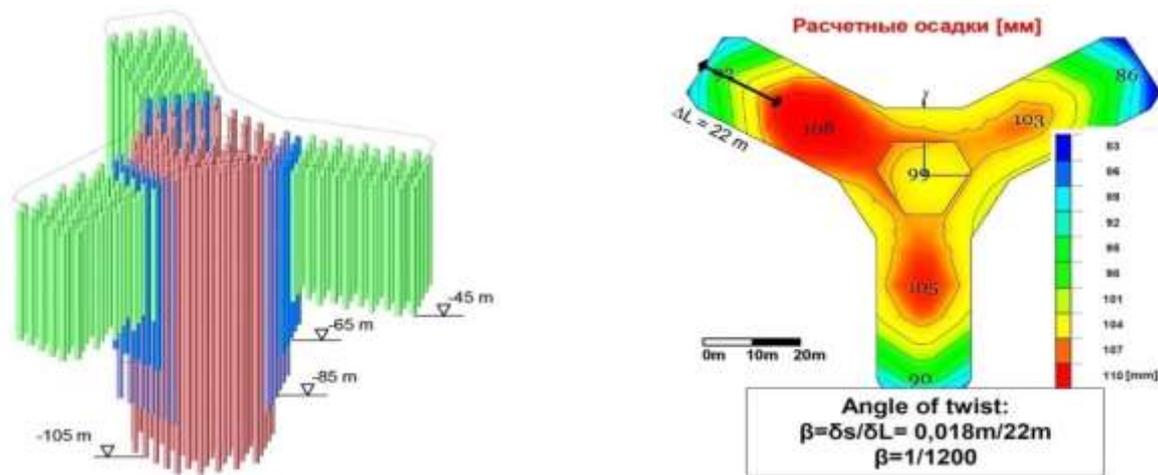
Схема распределения свай разной длины в пределах фундамента «Кингдом Тауэр» с указанием изополей расчетных осадок фундаментной плиты
